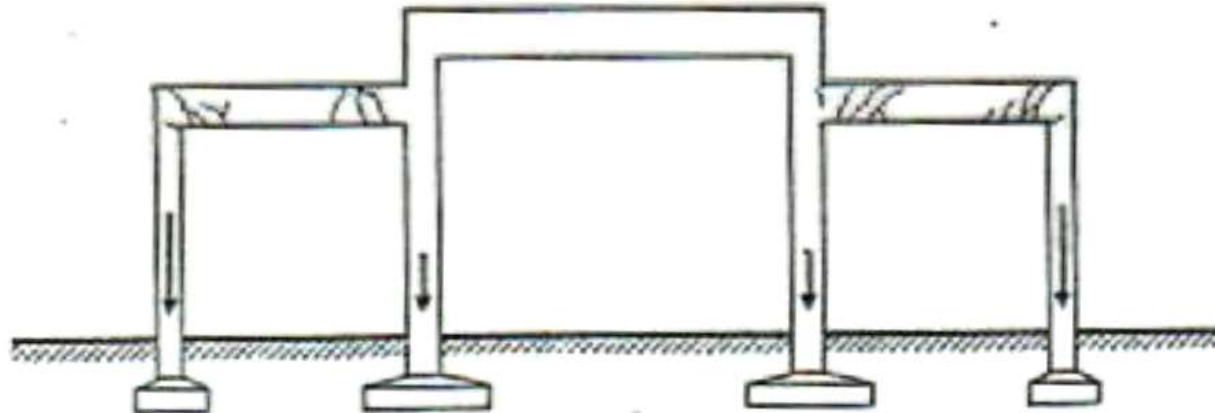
Grietas producidas en un pórtico triple por haber sido la carga sobre los pilares centrales menor de la prevista.
